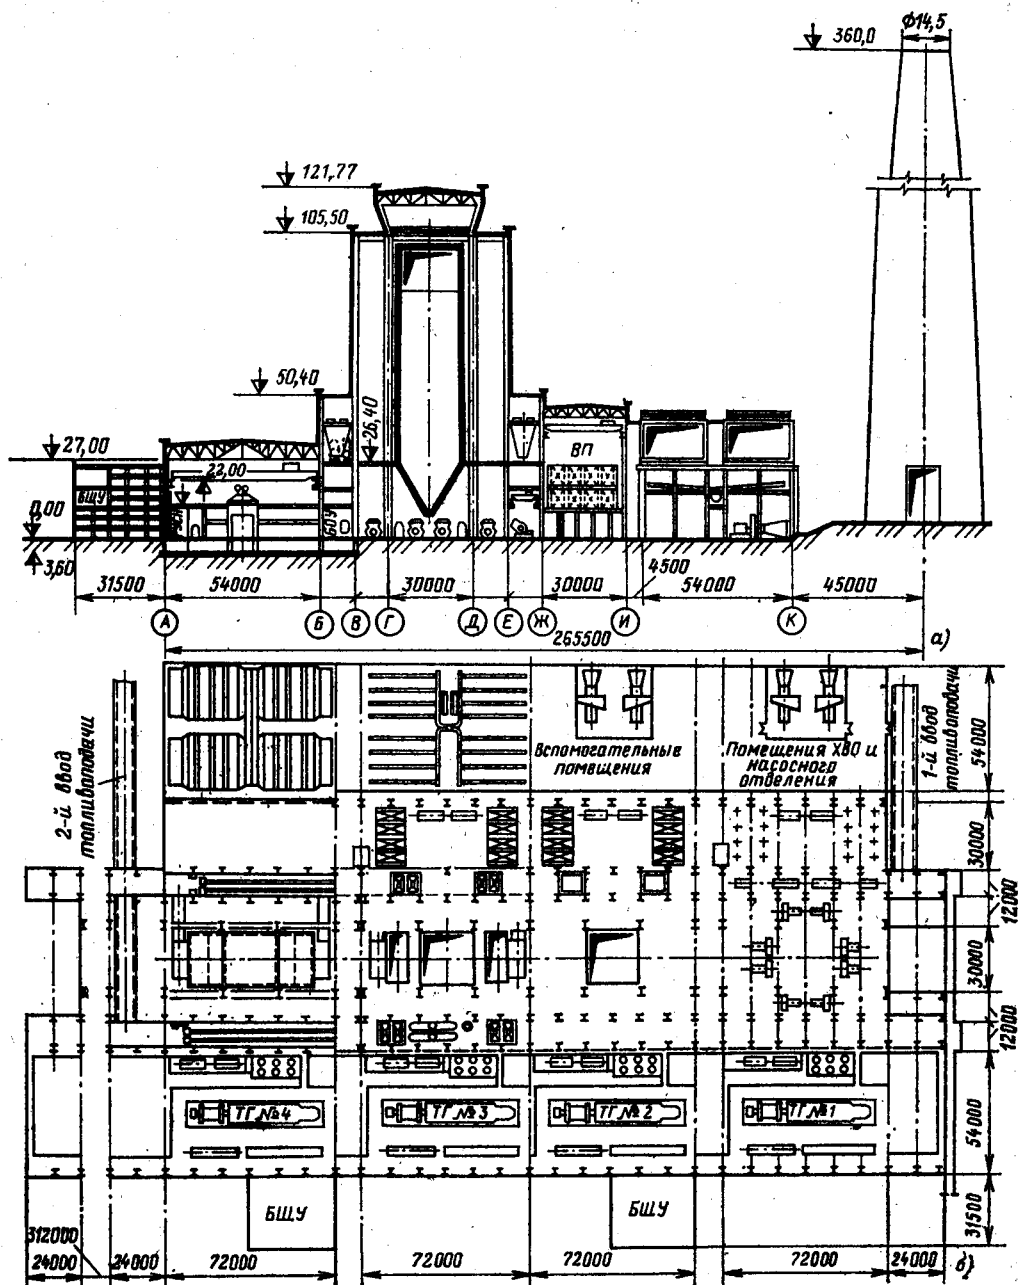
Поперечный разрез (а) и план (б) главного корпуса Березовской ГРЭС-1
